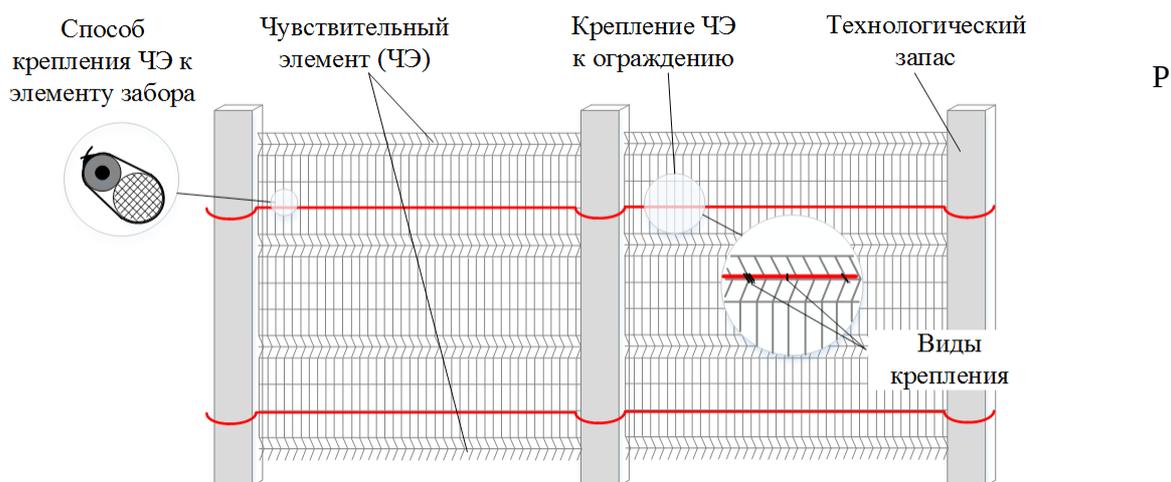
Размещение и закрепление ЧЭ на сварном заграждении из проволоки.
